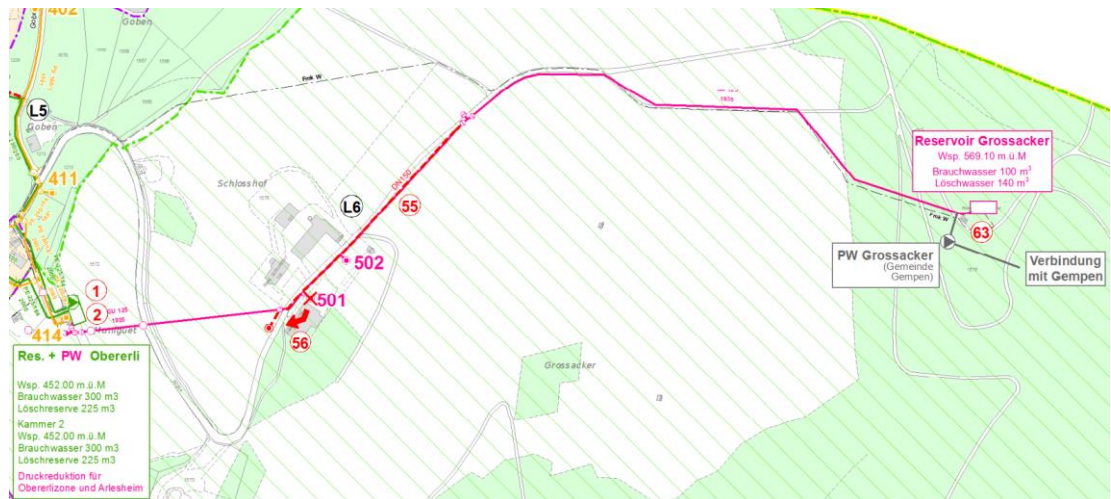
Ausschnitt aus dem Übersichtsplan (vgl. GWP, 2016, Planbeilage)
